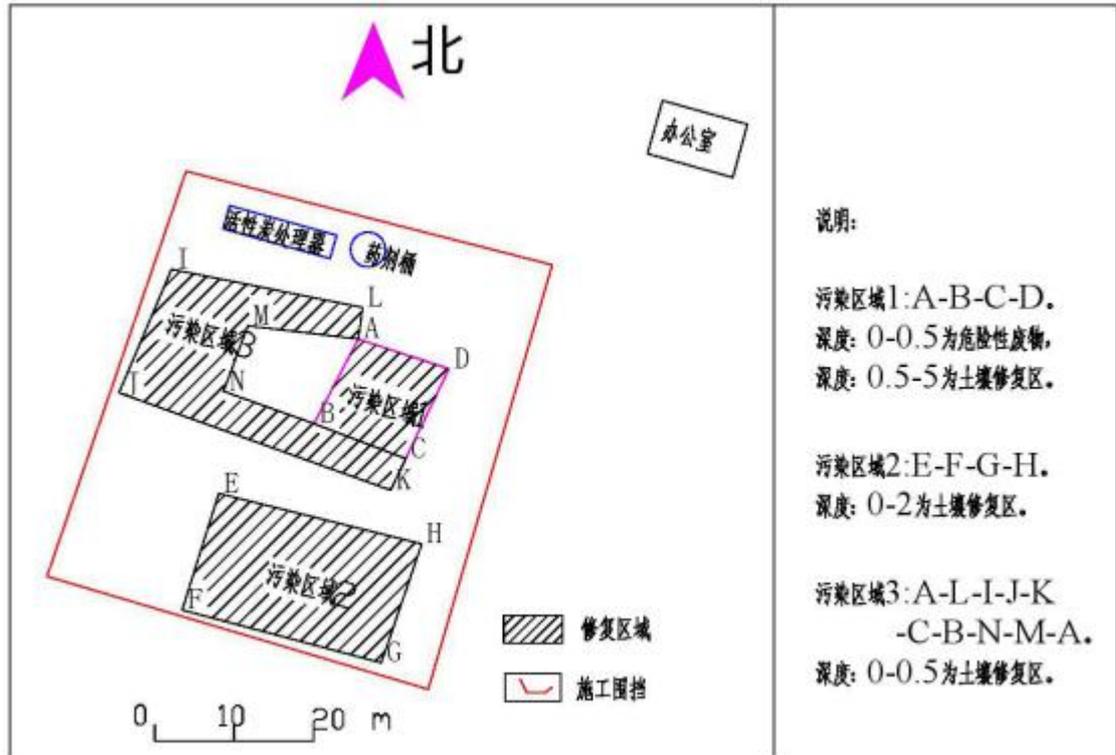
温陈办事处污染地施工平面图（红色线为施工作业面）
